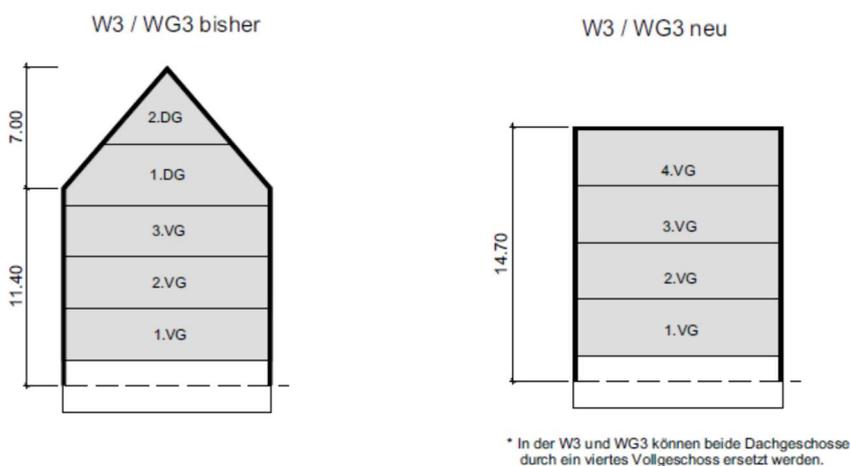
Ersatz der Dachgeschosse durch ein 4. Vollgeschoss bei Arealüberbauungen in der W3 und WG3 (eigene Darstellung)
